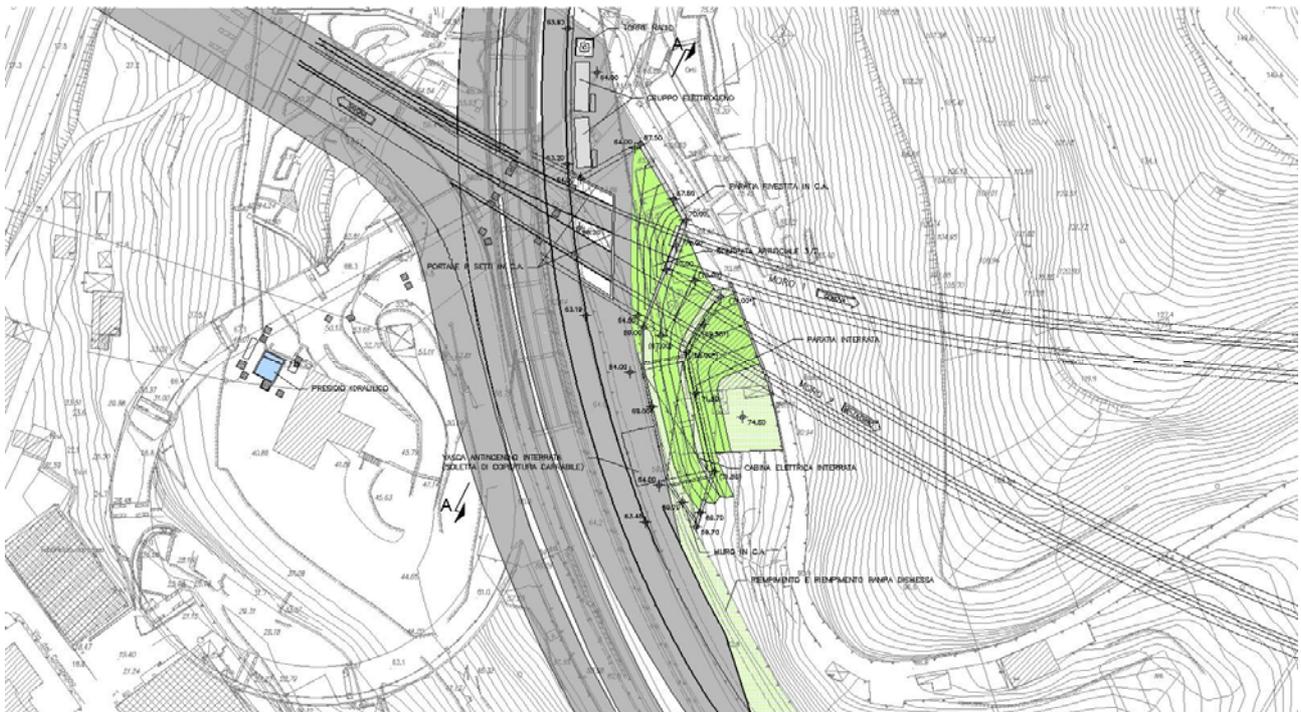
Planimetria dell'area d'imbocco delle gallerie Moro 1 e Moro 2 (cfr. AUA0196-1)
